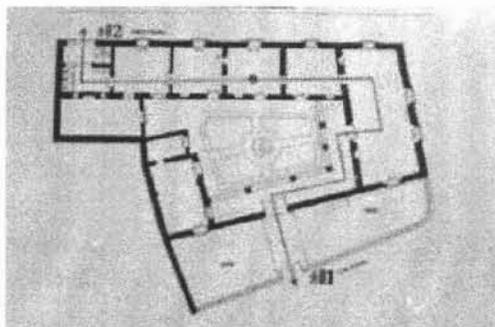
Planta arquitectónica de la Casa del Obispo, en San Ángel.
